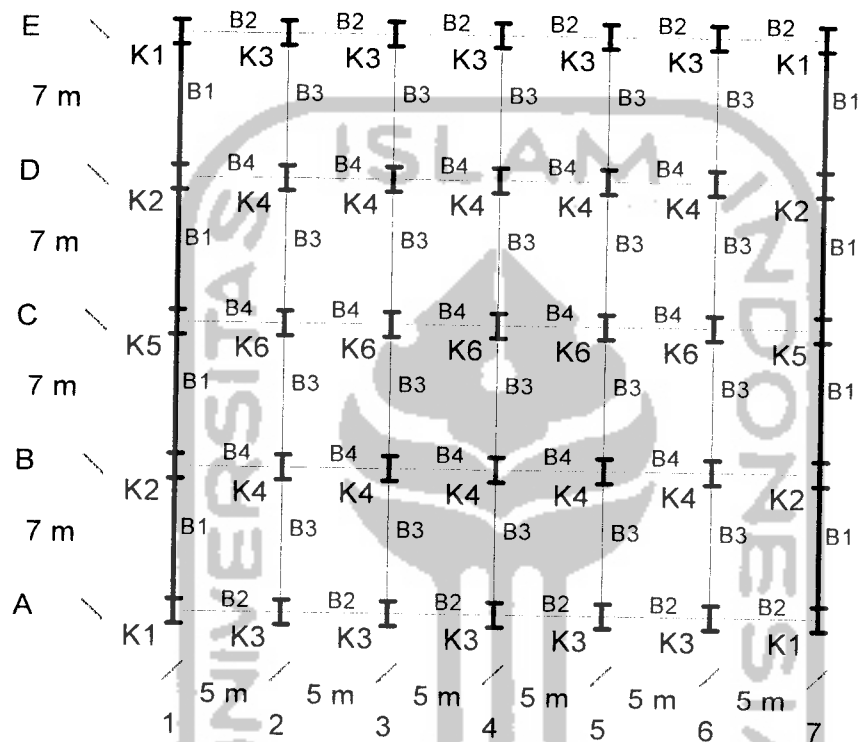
Rencana Penempatan Profil Struktur USF 14 lantai @3,75 m
